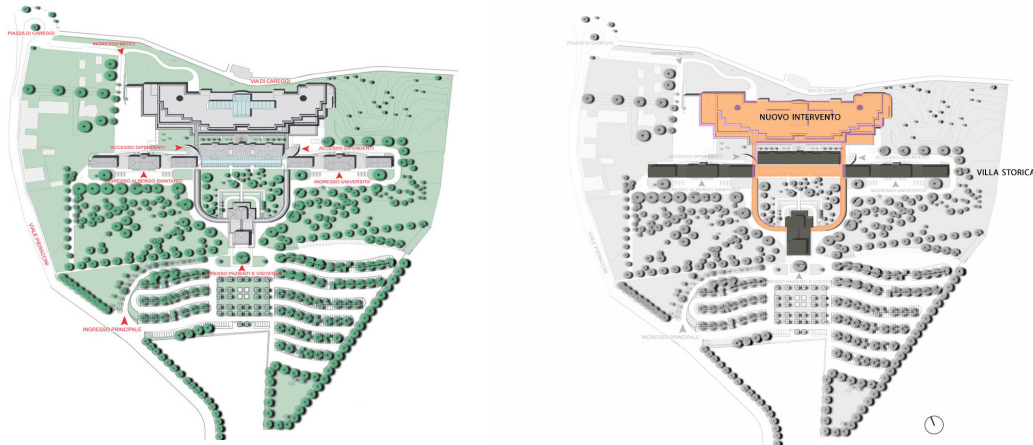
Azienda Ospedaliera Meyer. Planimetria dello stato di fatto (a sinistra) e planimetria del nuovo intervento (a destra)
